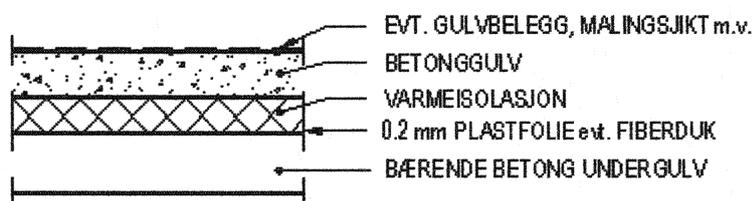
d: Flytende betonggulv på isolasjon.
